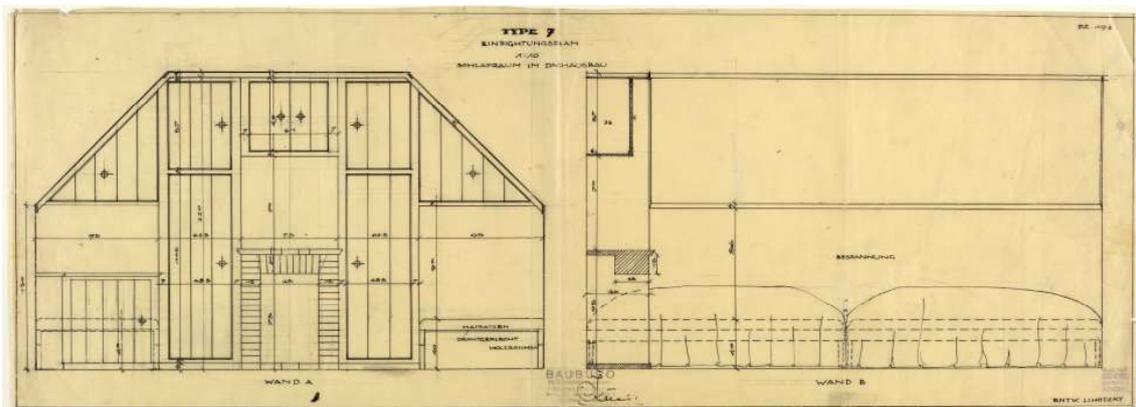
Schlafraum im Dachausbau.Einrichtungssplan.Wand A
